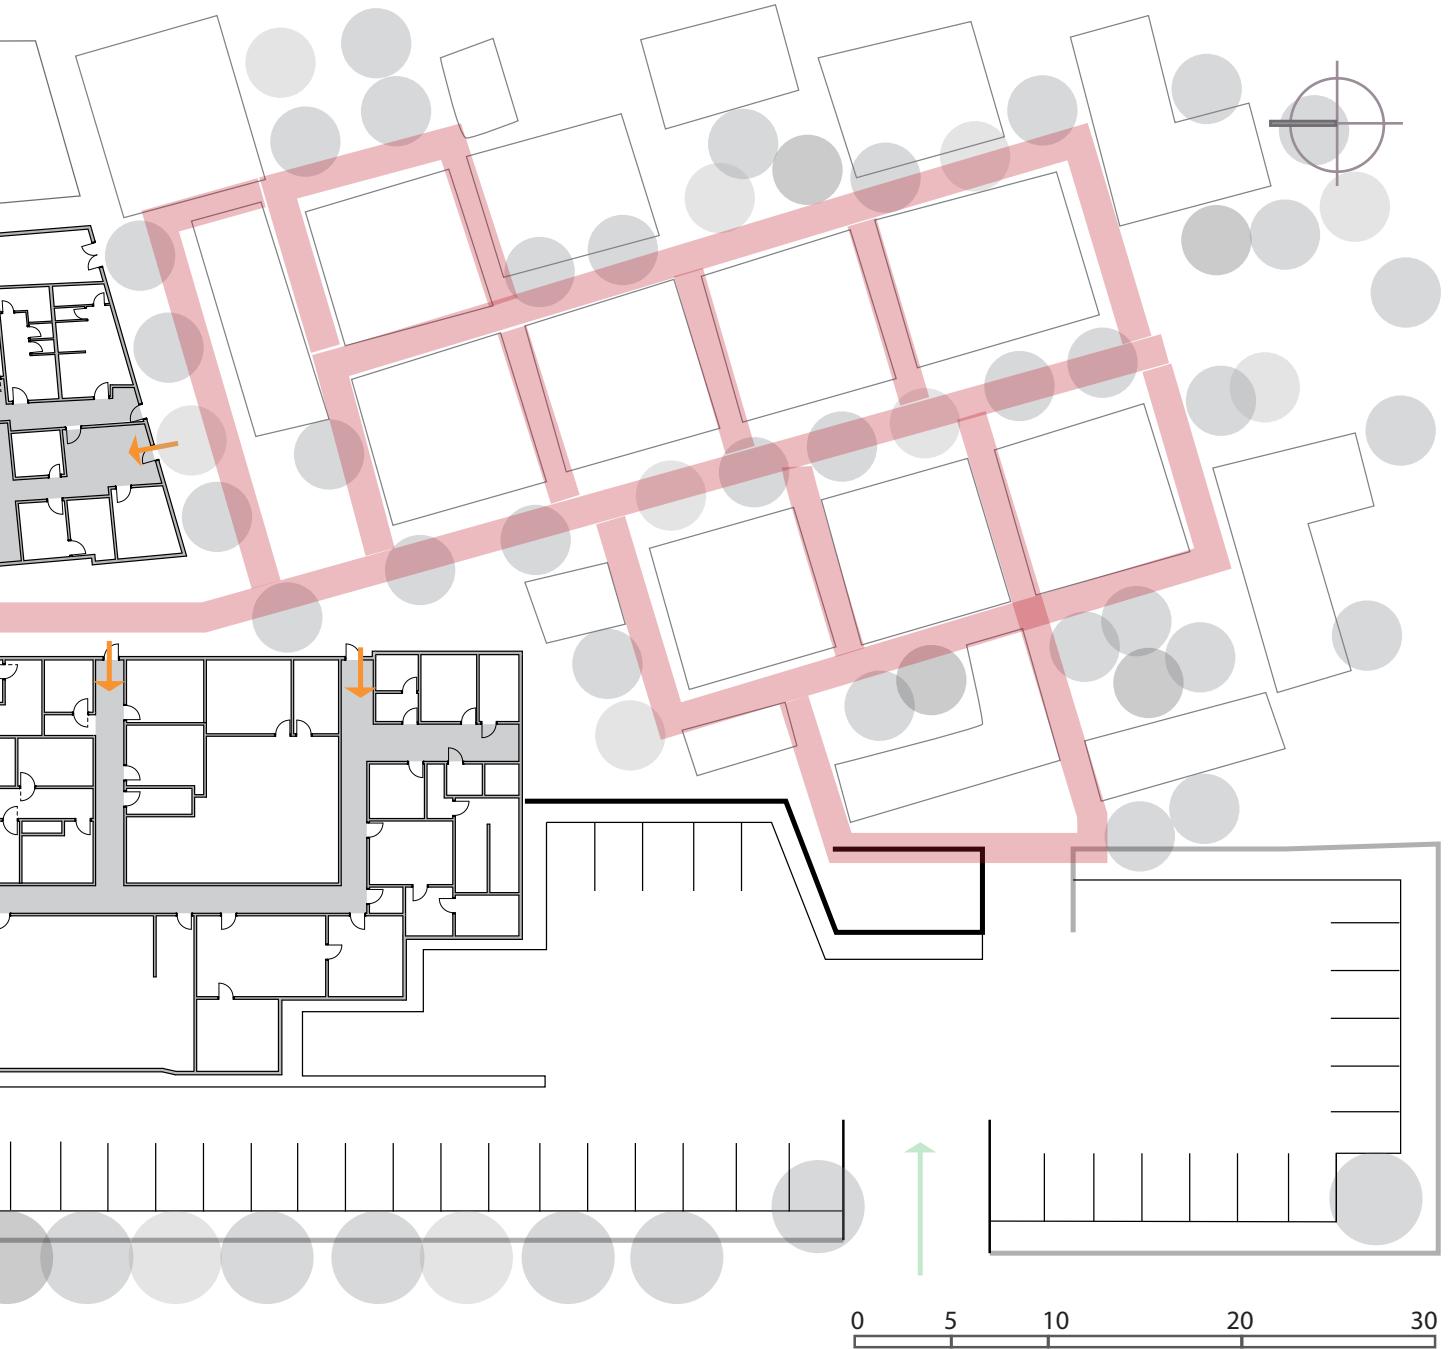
Circulaciones y accesos planta proyecto del sur de Los Ángeles.
